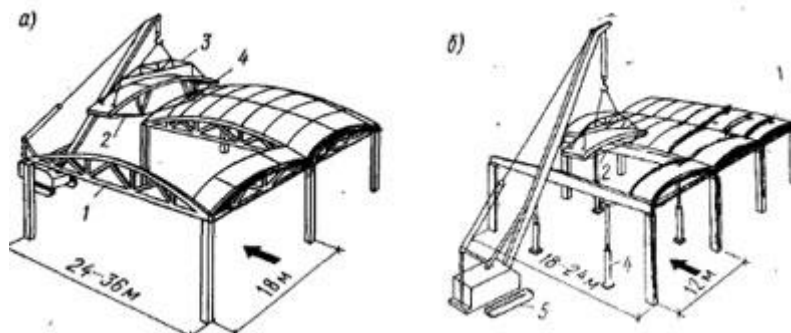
Схемы монтажа оболочек с опиранием на несущие конструкции
